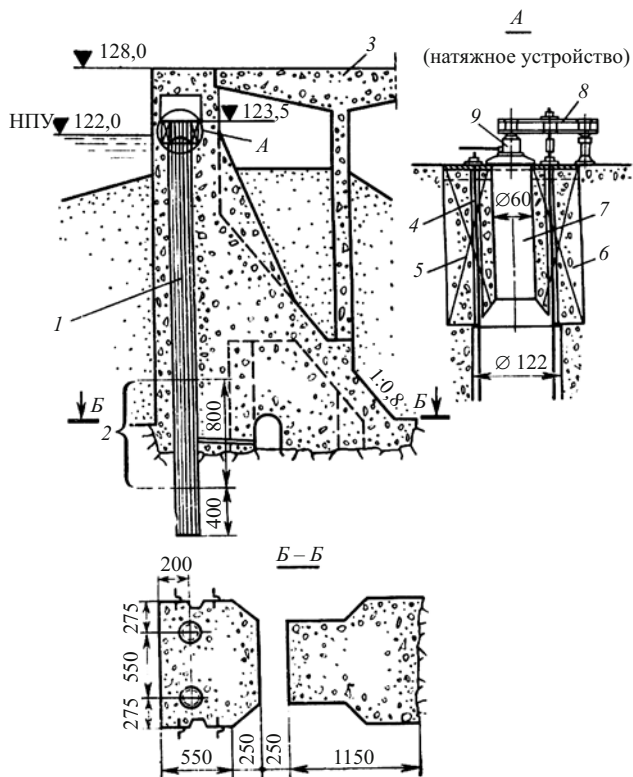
Поперечный разрез опытной секции глухой бетонной плотины:
